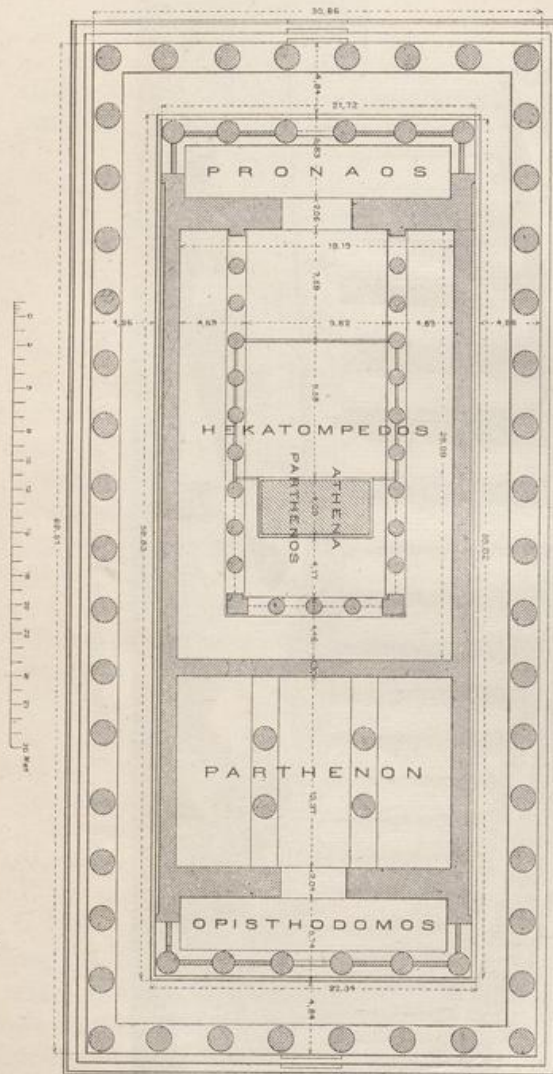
Grundriss des Parthenon. (Nach Treu.)
